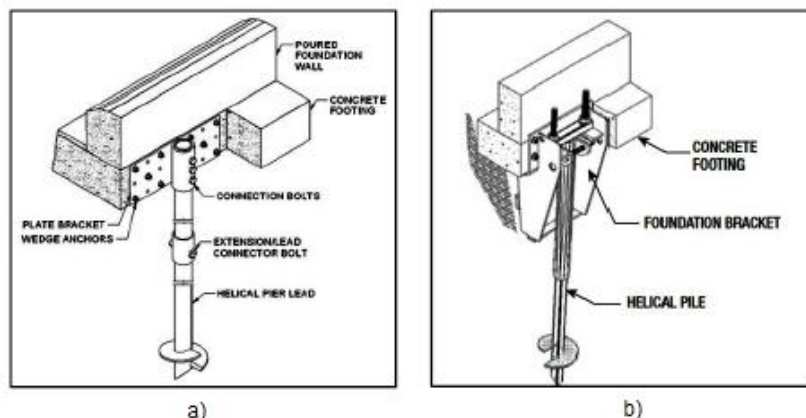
Ligações com braçadeiras: a) Braçadeira plana b) Braçadeira em L[15]
